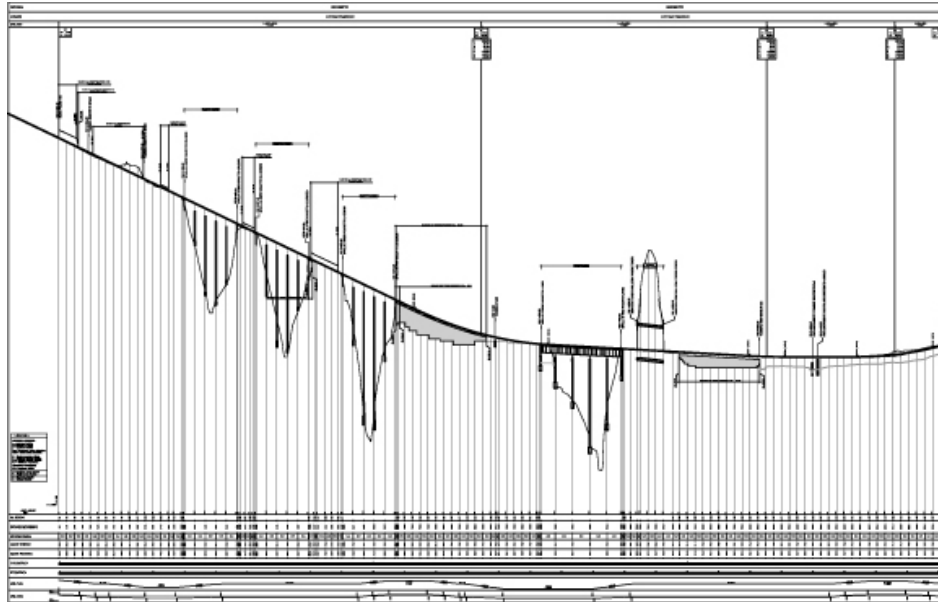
Progetto esecutivo Lotto 4 - Profilo
